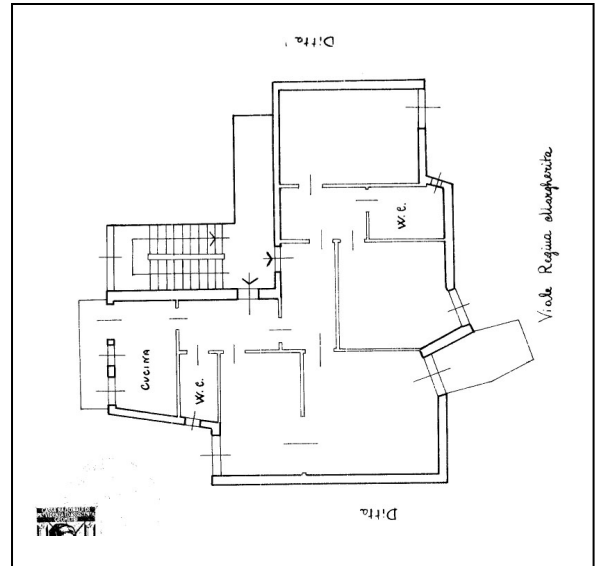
Estratto planimetria catastale di impianto del 30/11/1966
